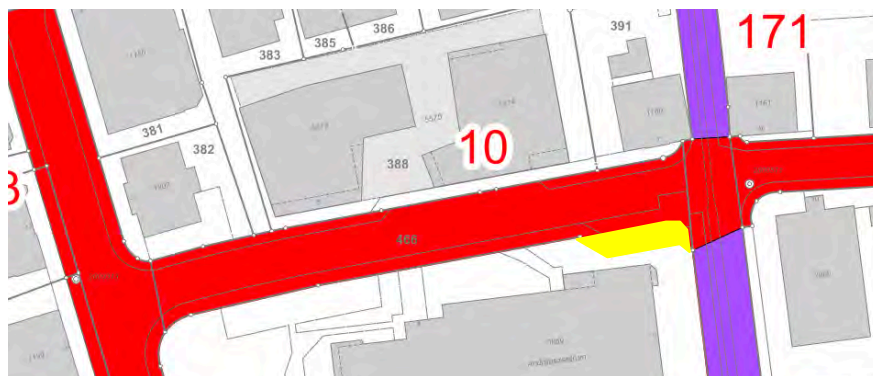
Änderung Strassenplan Kirchstrasse (ohne Massstab)
